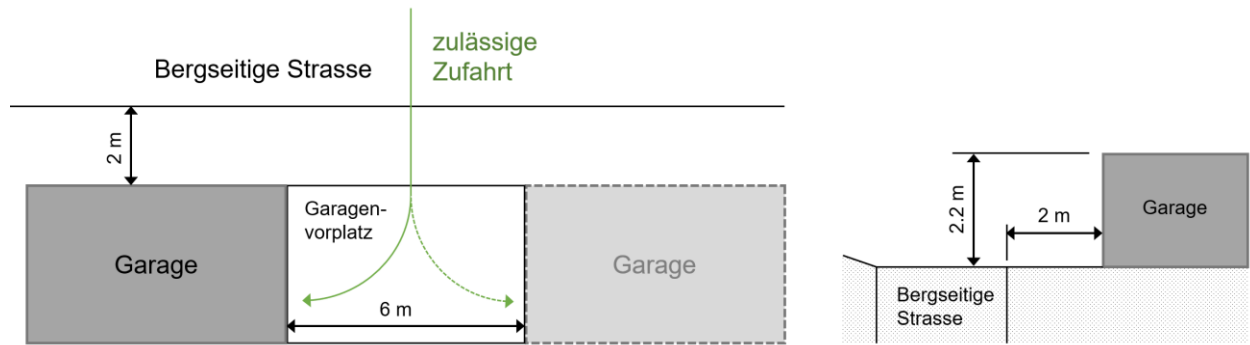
Skizze Lange Garagenvorplatz (links) und Fassadenhohe (rechts)
